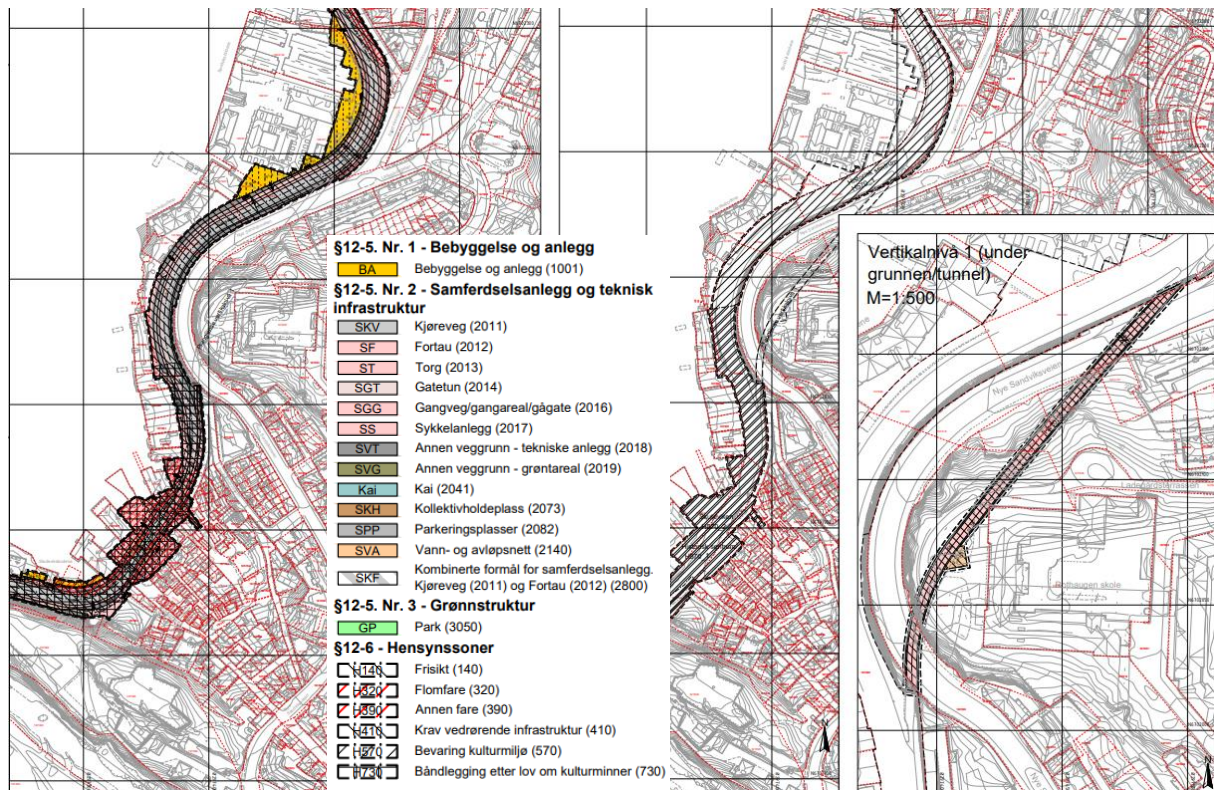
Utsnitt av bybaneplan, adkomst ved Sandviken kirke, på grunnen
